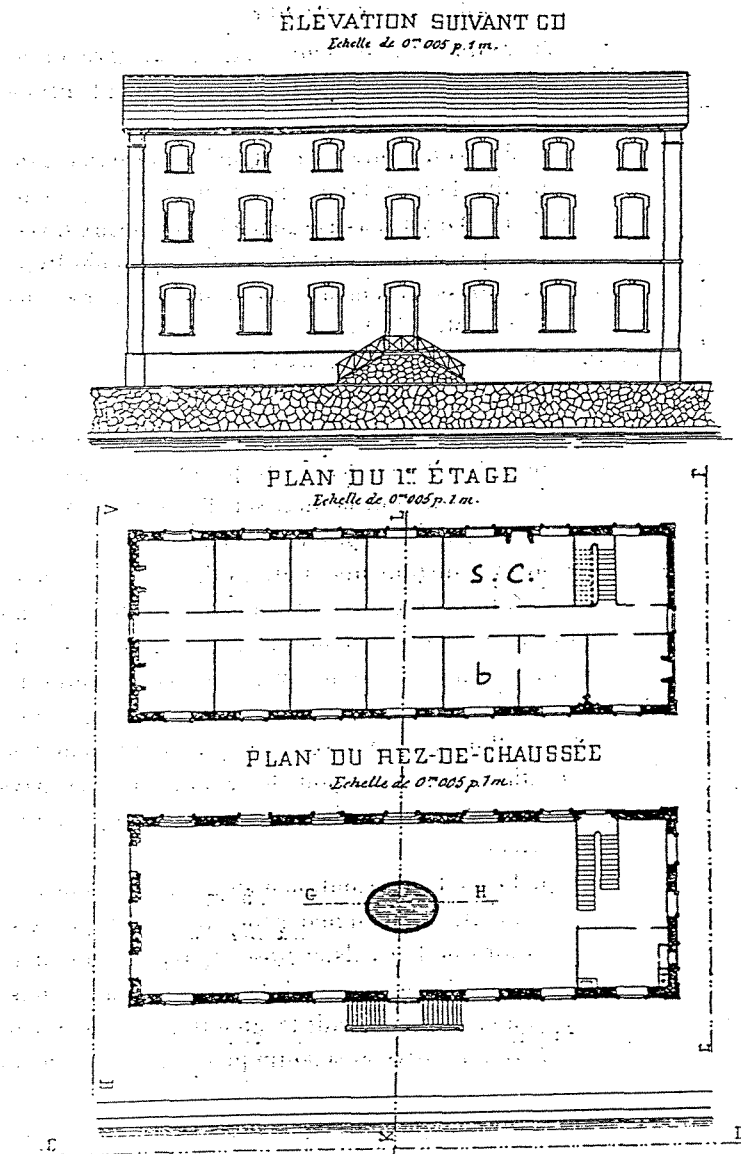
Plans des bâtiments du laboratoire Arago.
